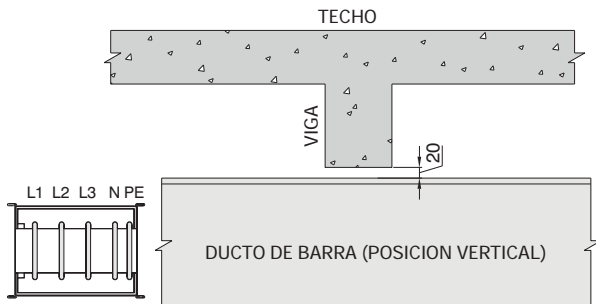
POSICIÓN VERTICAL DE CRUCE BAJO VIGA
